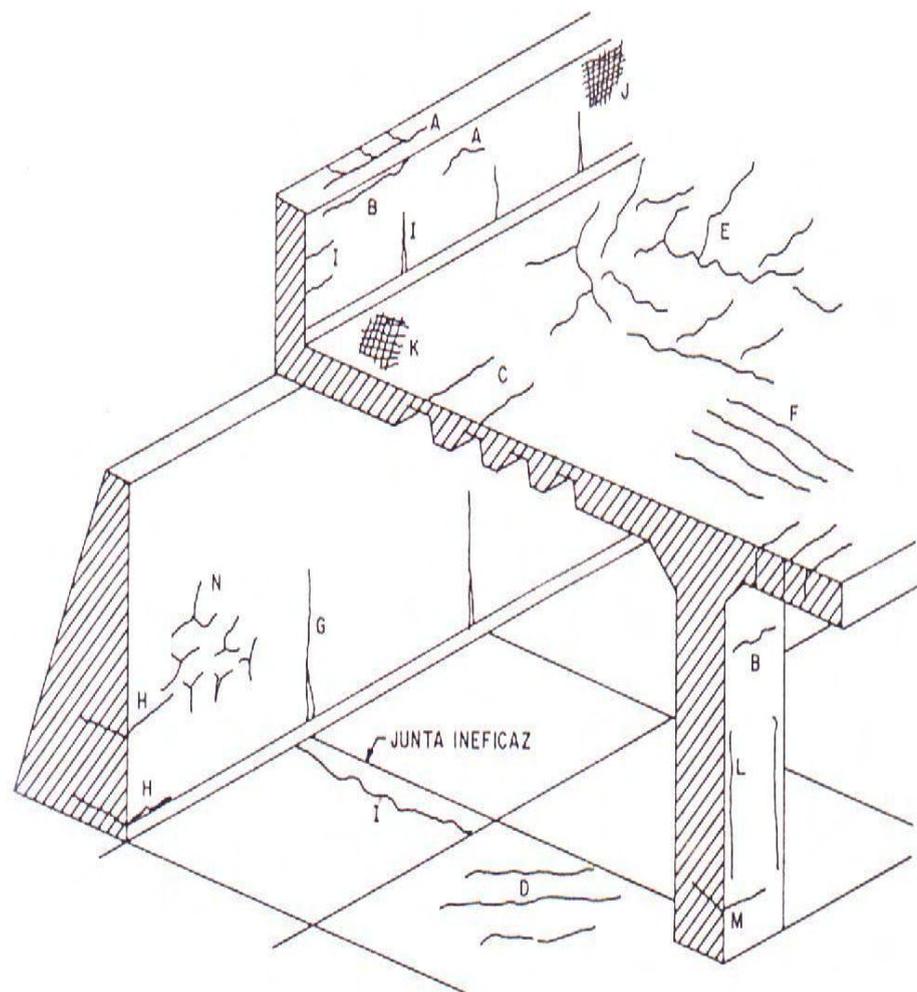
Tipos de fissuras frequentes em estruturas de concreto. FONTE: CÁNOVAS (1994).
